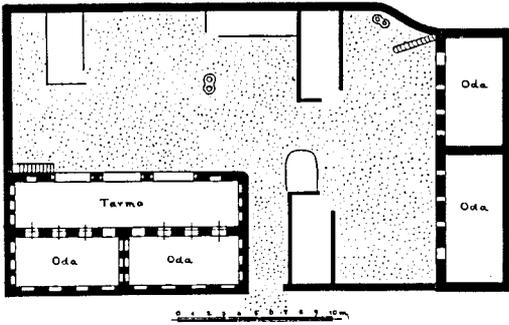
Haus des Abbäs el Dschäsım, Koweiresch. Grundriß.
